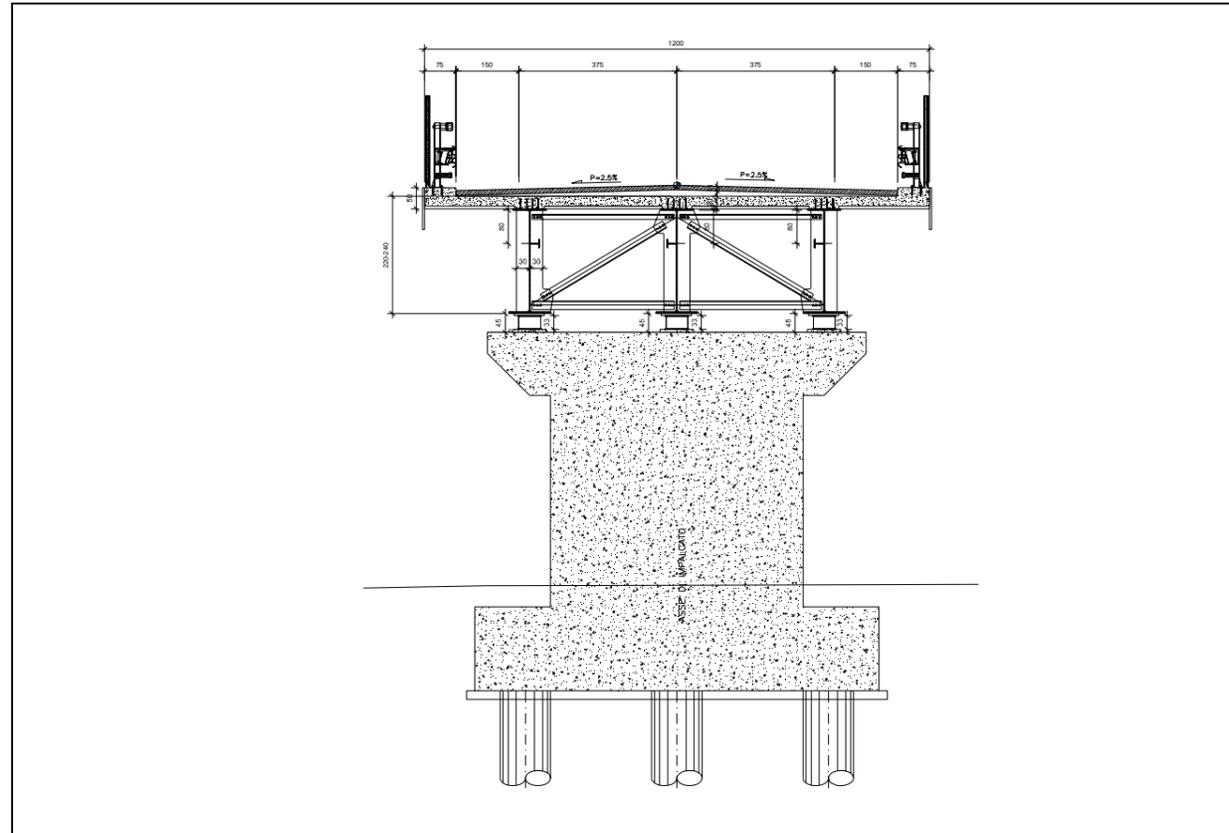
Viadotto di progetto: Sezione trasversale dell'impalcato
